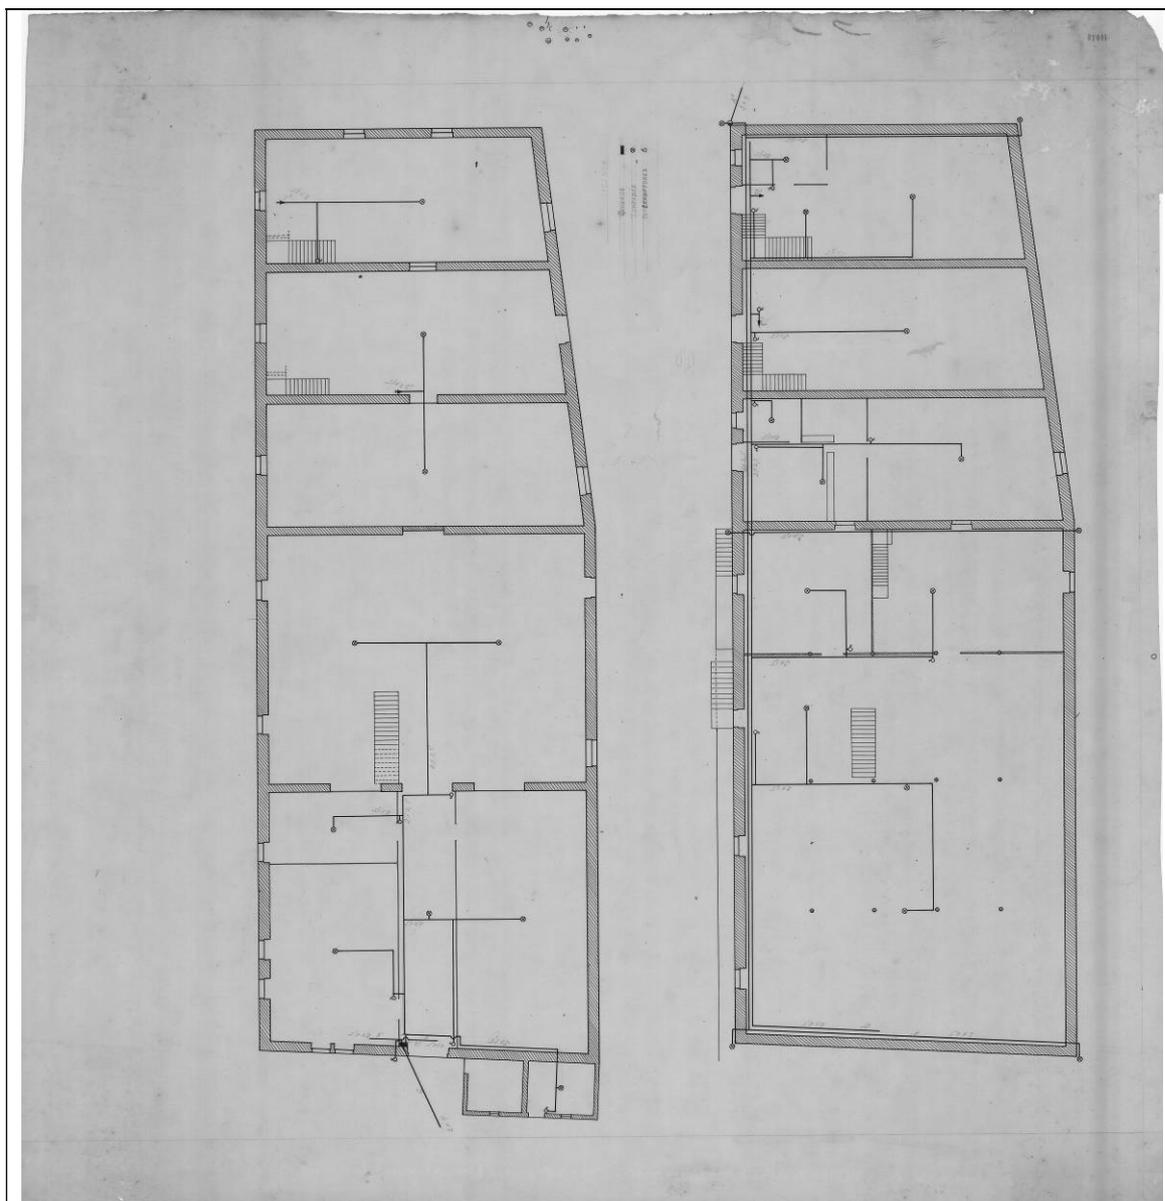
Planta das naves do armazém de Rio Tinto, à escala 1:20 (Fonte: Museu Mineiro de S. Pedro da Cova)
